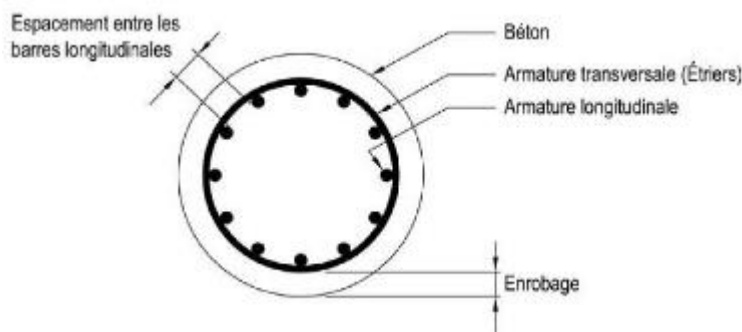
Section circulaire à 12 armatures longitudinales
